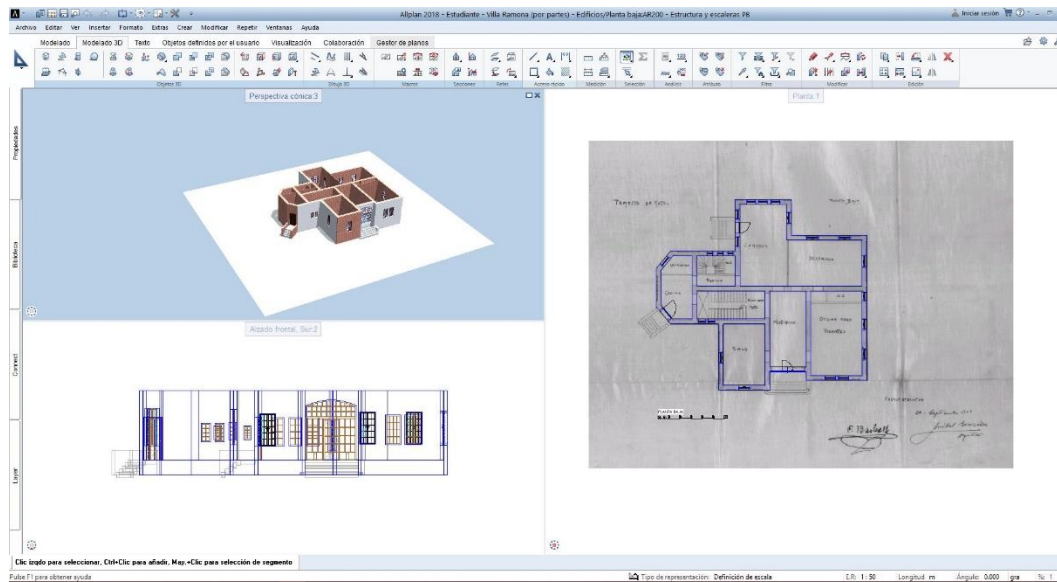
Generación planta baja. Elementos constructivos generales Allplan 2018. Fuente: Elaboración propia
